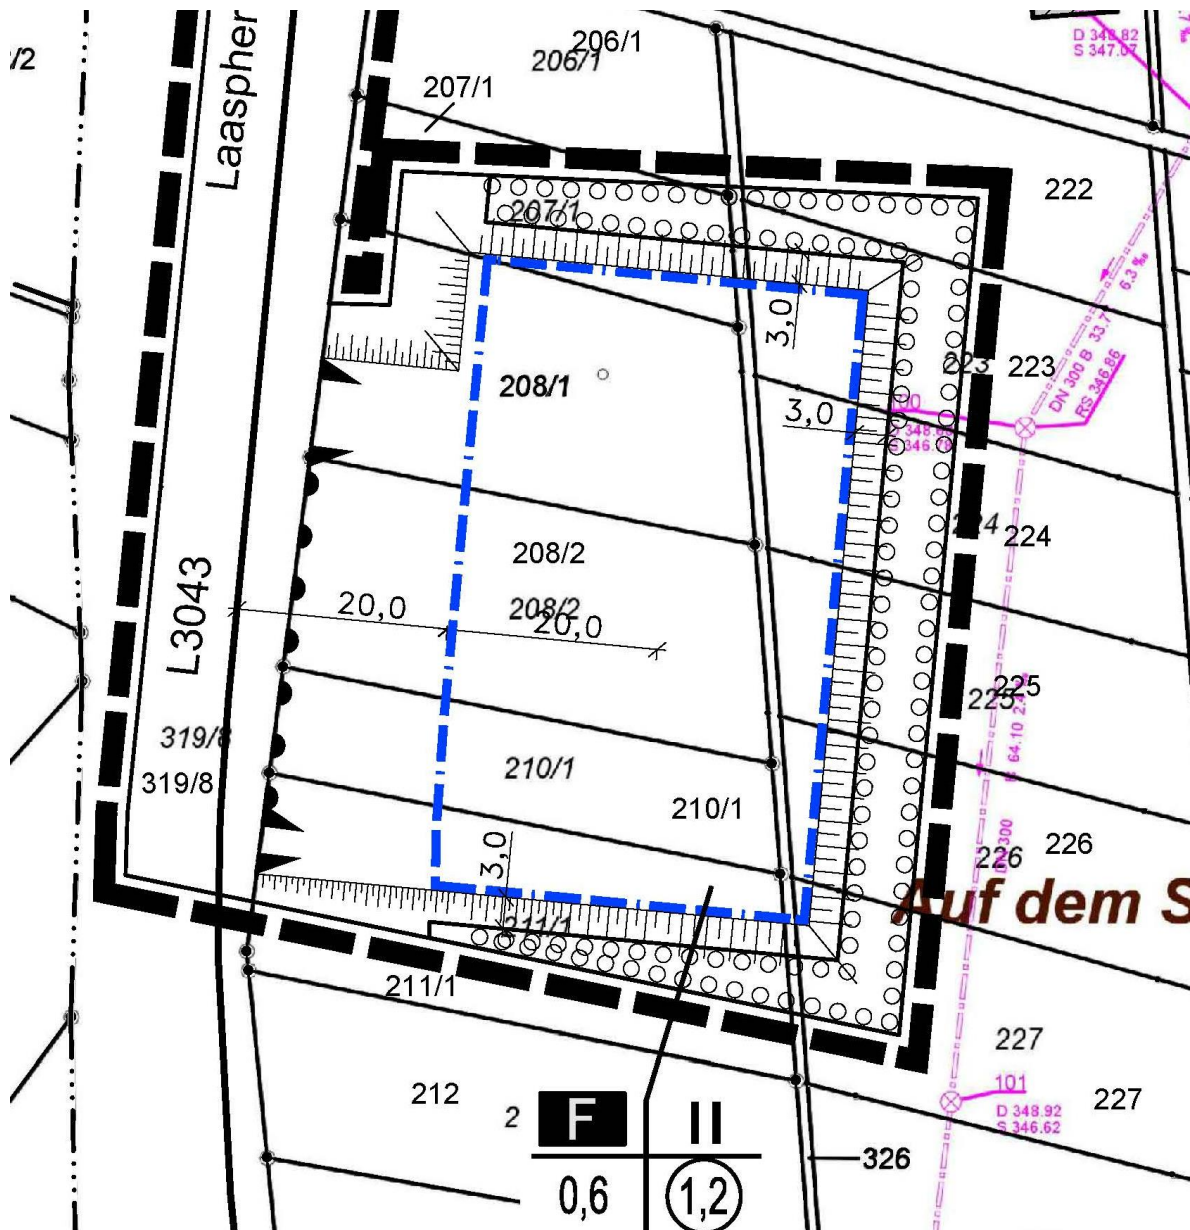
Auszug aus dem Lageplan der Kanalisation mit Eintrag des Bebauungsplanes
